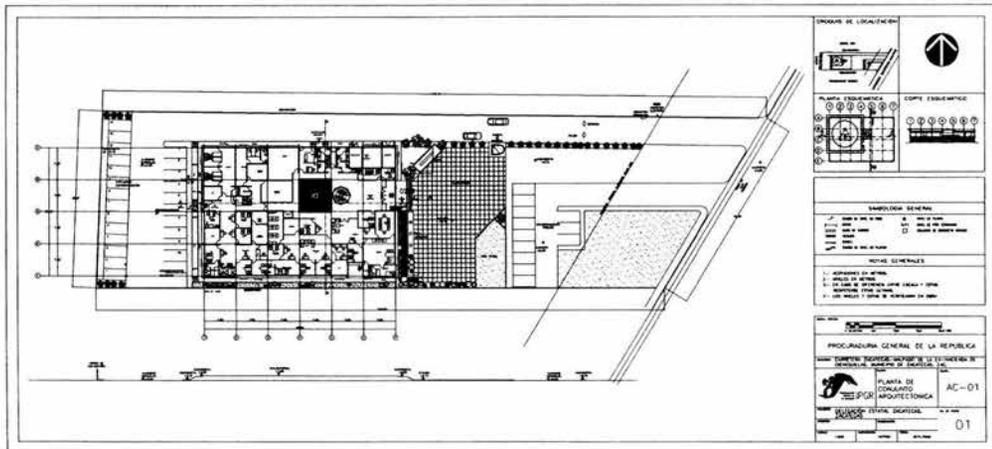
PROYECTO EJECUTIVO PLANTA DE CONJUNTO
